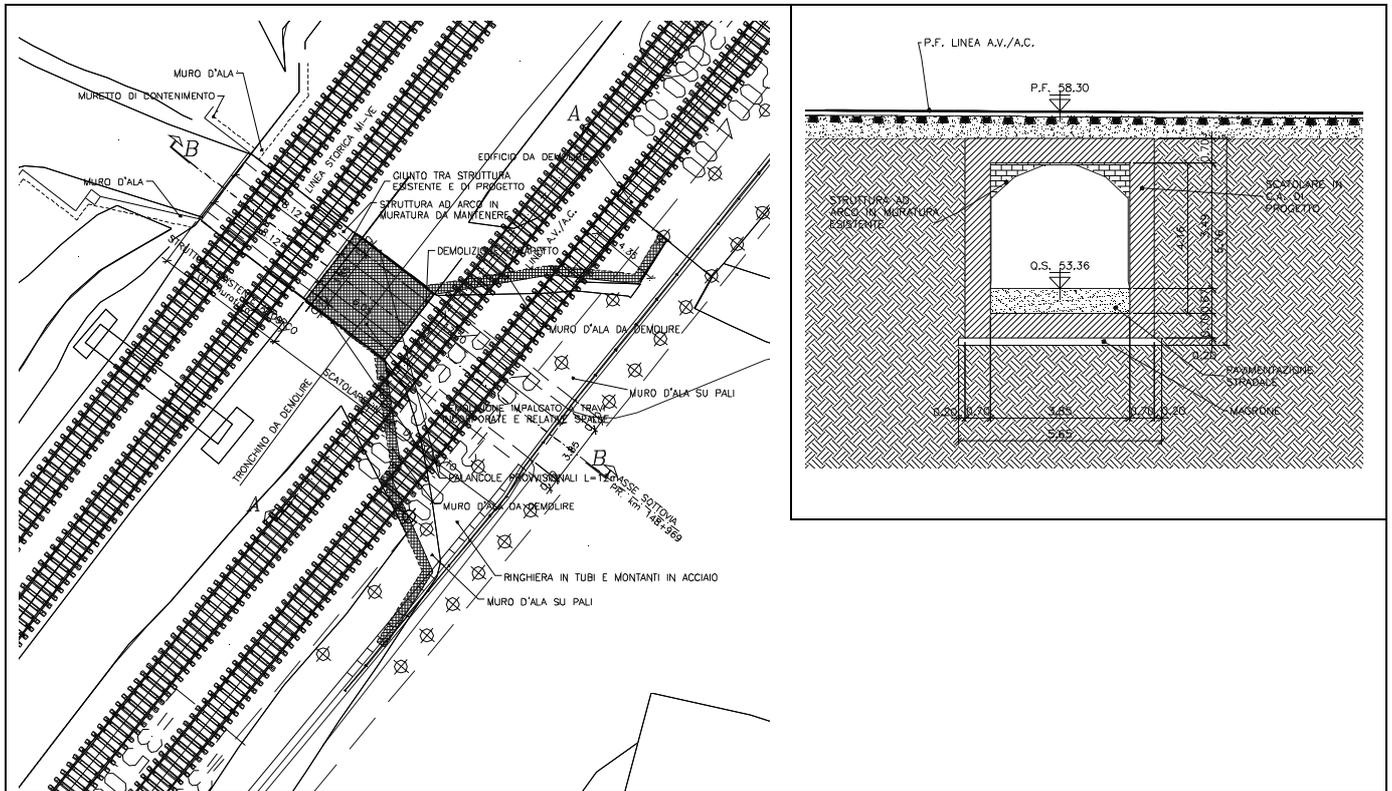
Planimetria e sezione di progetto di via Campo Marzo
